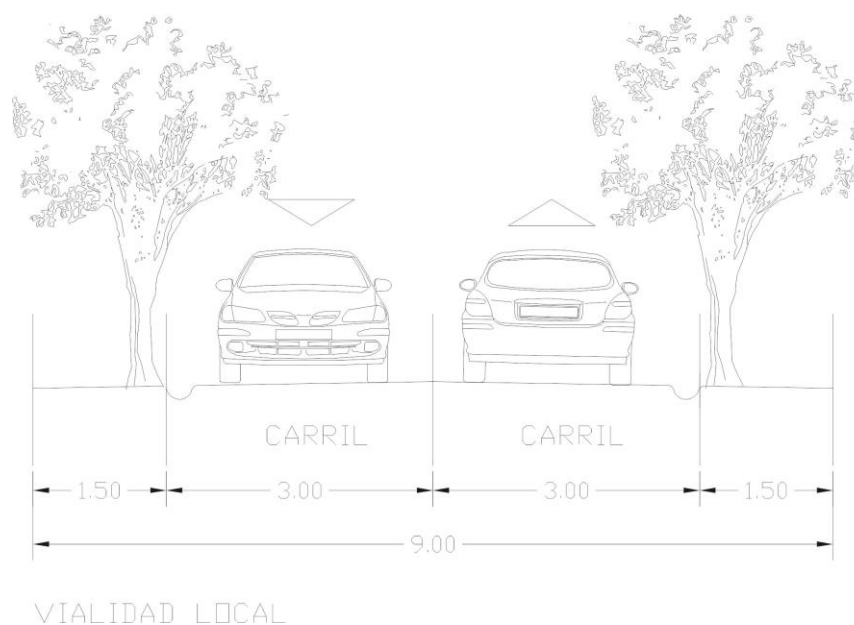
Sección de calle propuesta para las vialidades locales proyectadas en el área de aplicación.
